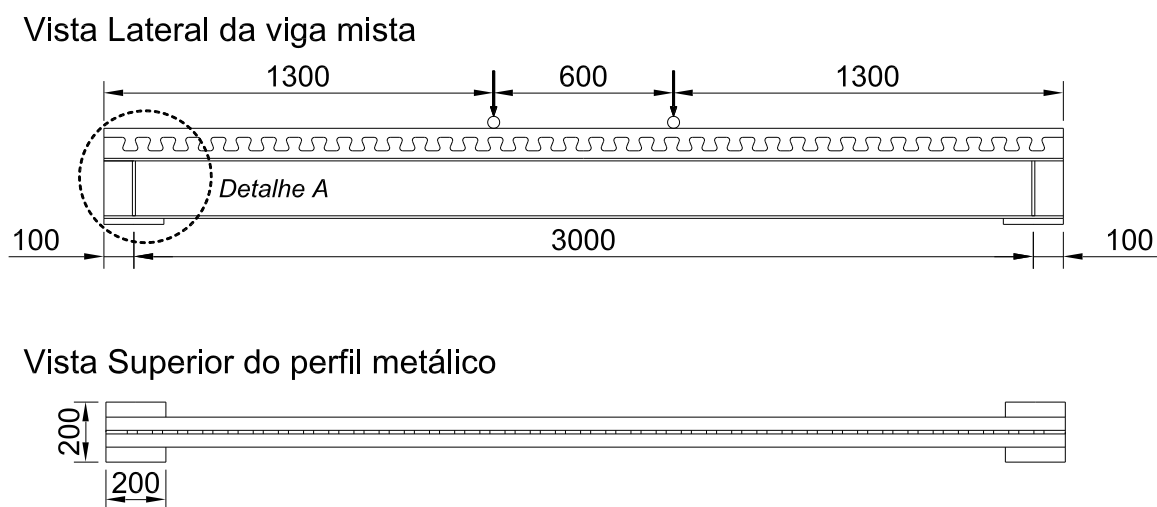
Vista lateral da viga mista (geometria e aplicação de carga) e vista superior do perfil metálico (dimensões em mm) ensaiado por Alves (2014).
